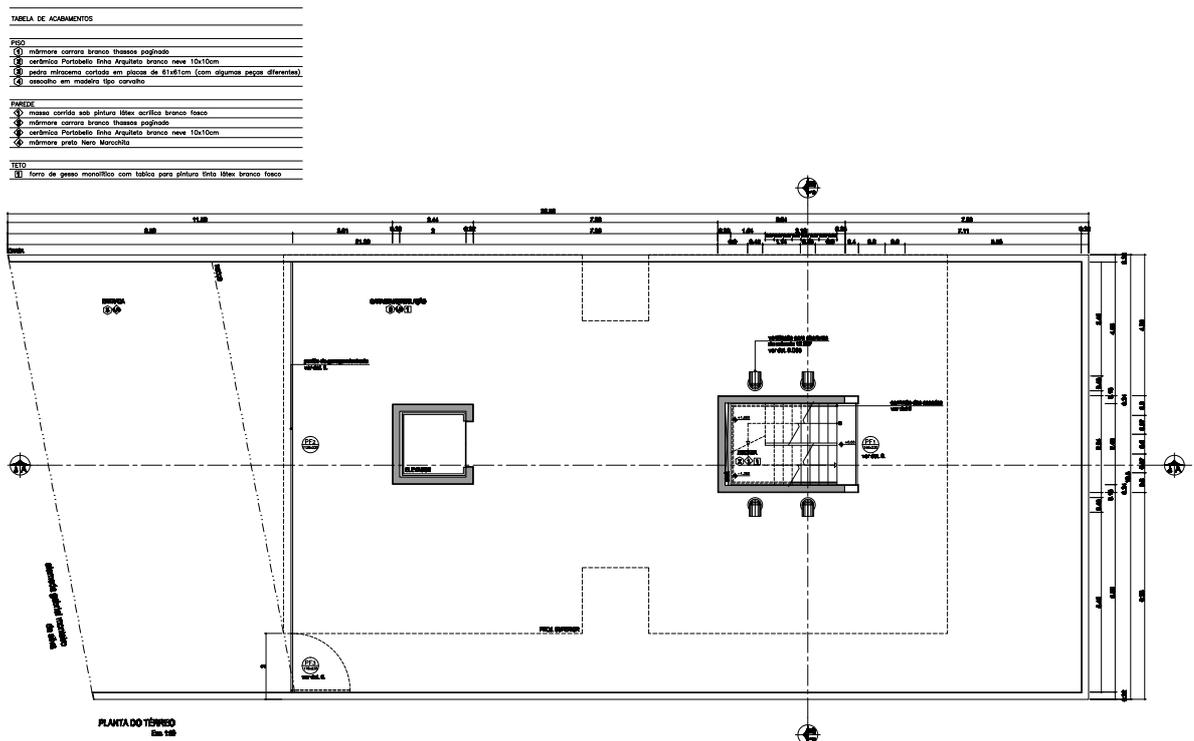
13 - Planta baixa térreo (acervo Inter/design).
